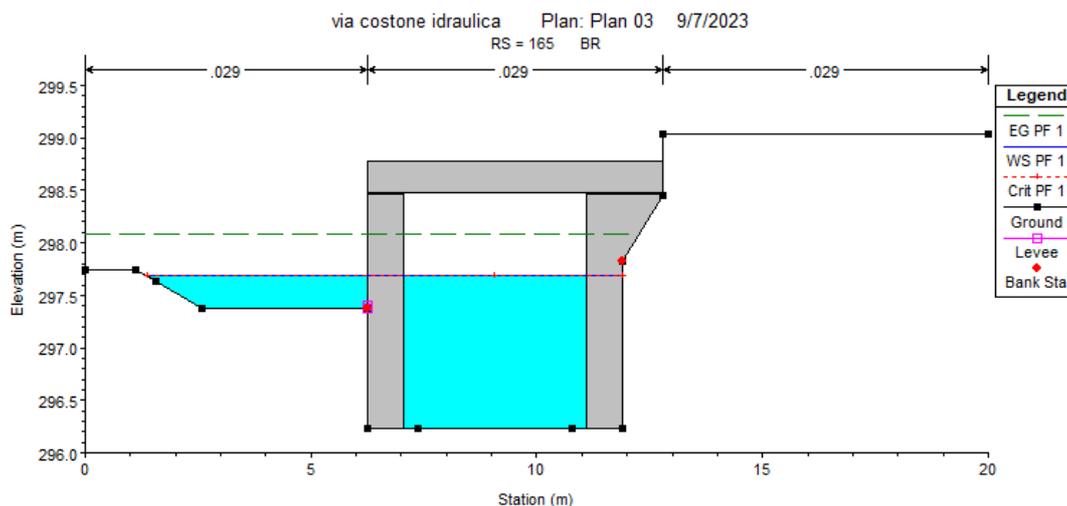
Progetto Rev. 09/2023 – Sezione n.165 ponte stradale condizione stato di progetto – tirante idrico corrispondente alla portata al colmo di 18,89 m<sup>3</sup>/s
